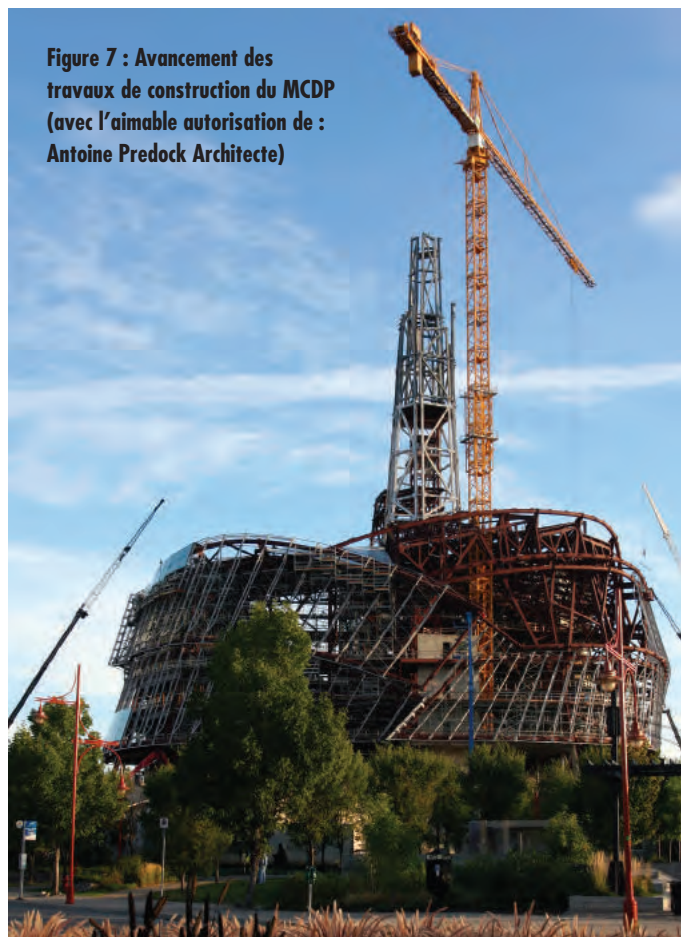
Avancement des travaux de construction du MCDP (avec l'aimable autorisation de : Antoine Predock Architecte)
